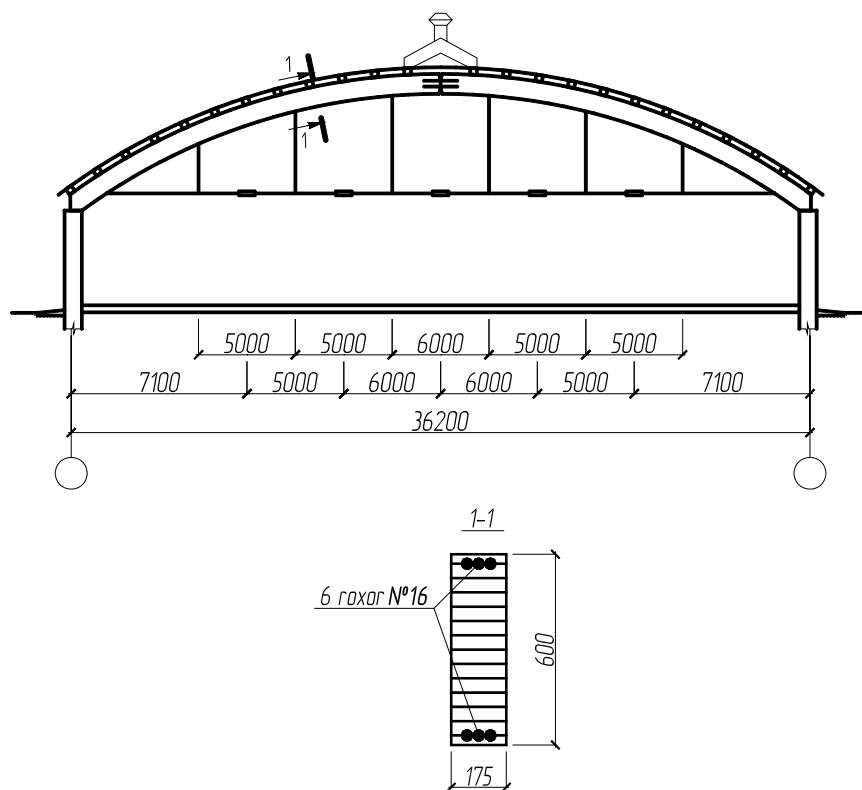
Клееная армированная арка в покрытии цеха химического завода (ЧССР)
